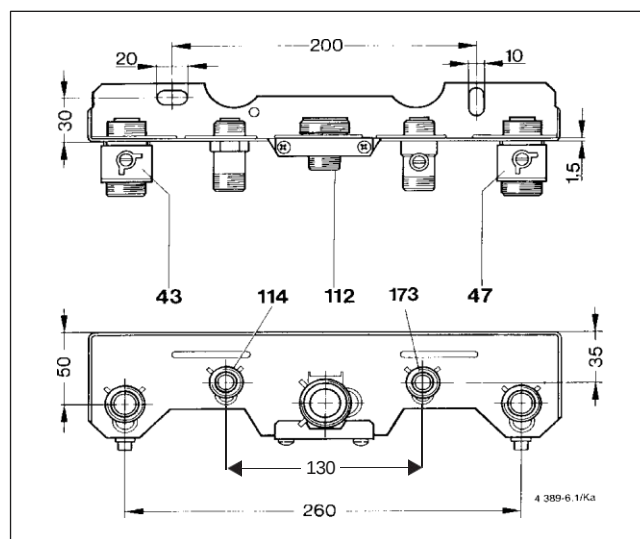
GC8700iW 30/35 C/CB (obdobně i pro GC8700iW 30 P/PB), ale bez deskového výměníku pro přípravu TV
